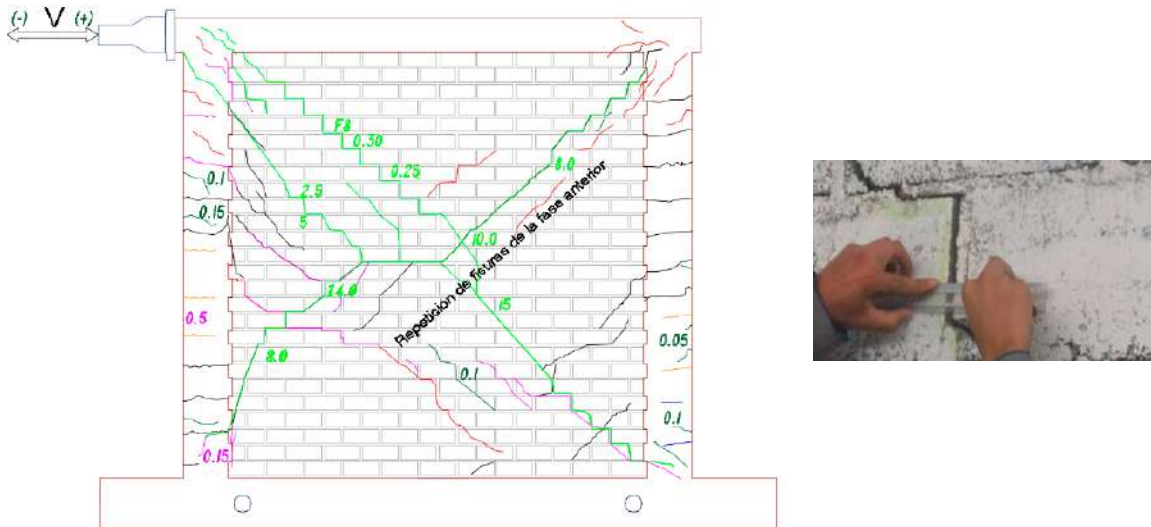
Muro agrietado diagonalmente de la fase 8 con repetición anterior (muro agrietado de la fase final en diagonal)
